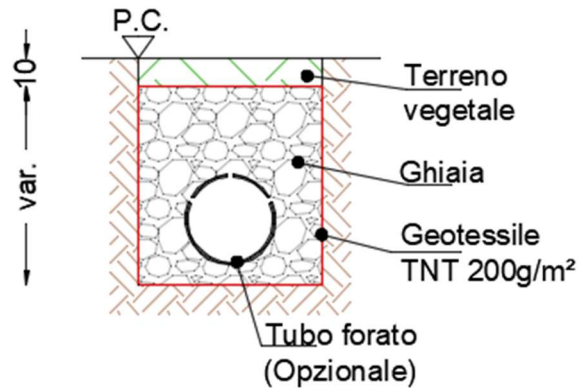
Sezione tipo di trincea drenante - misure in cm
